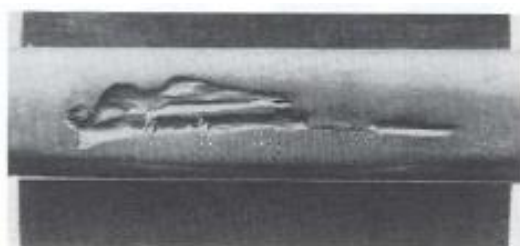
Desintegração da superfície de rolamento (Mourão, 2017)
